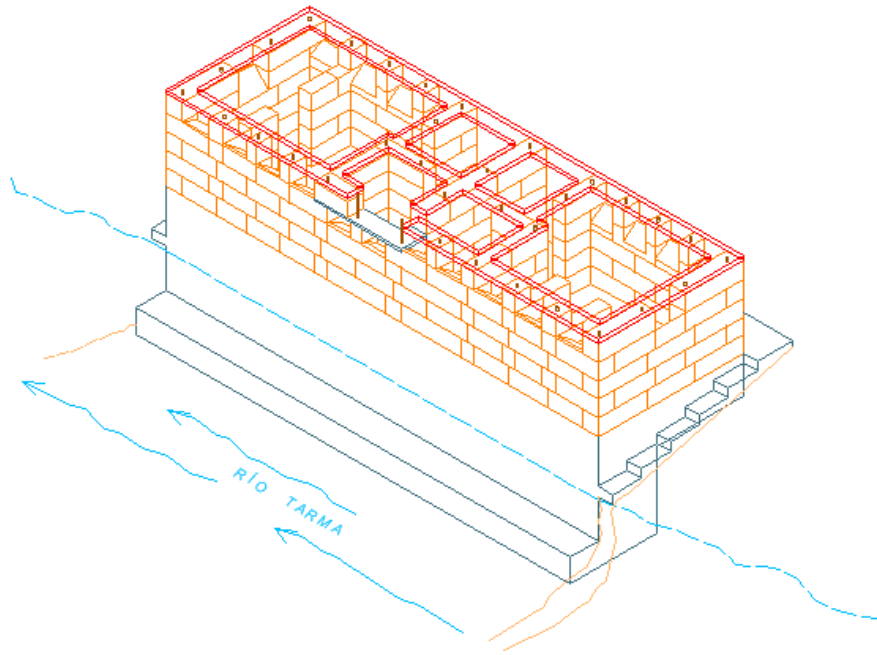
Encofrado del dintel “collarín” de concreto armado C/3 ø3/8”, H=0.13M
